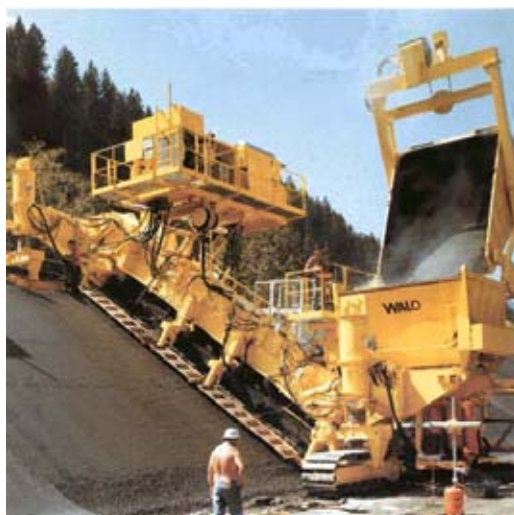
Acabadora horizontal para pavimentação da face (Walo, 1997a).
